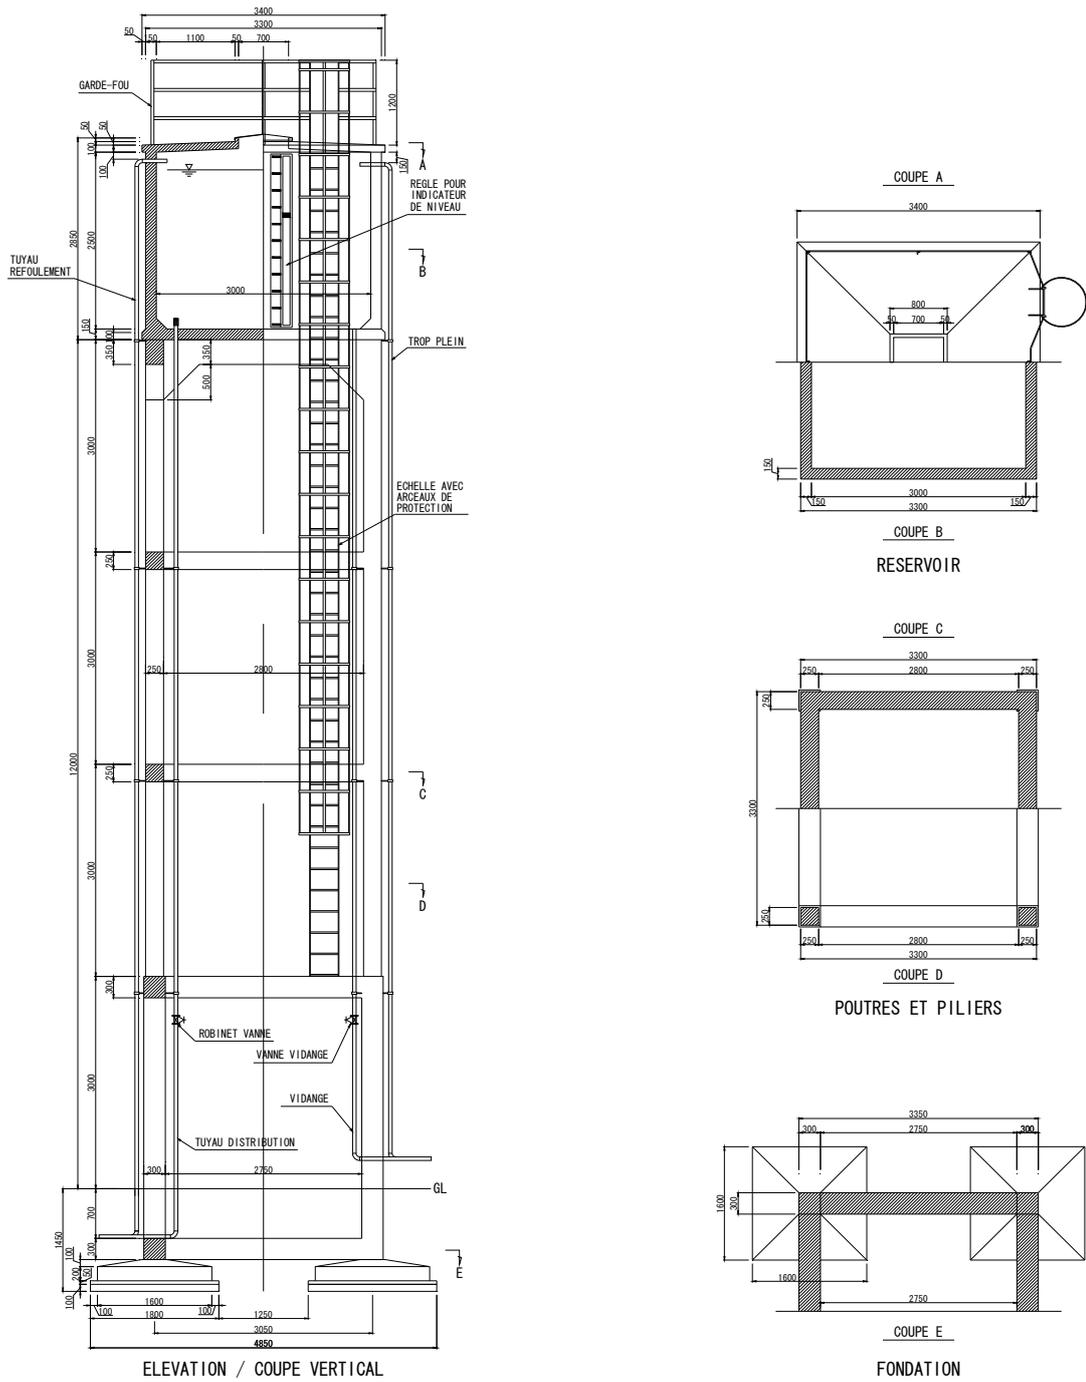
Plan structural de réservoir surélevé 20 m³ H=12 m
